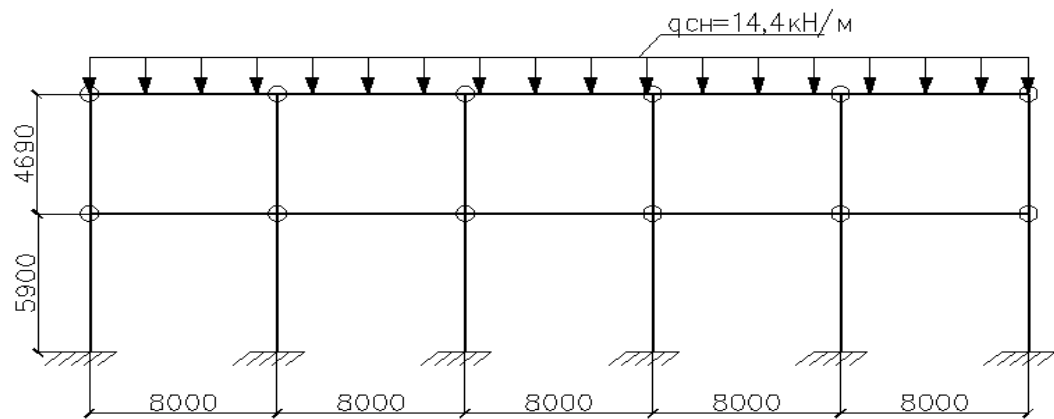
Розрахункова схема рами щодо снігового навантаження
